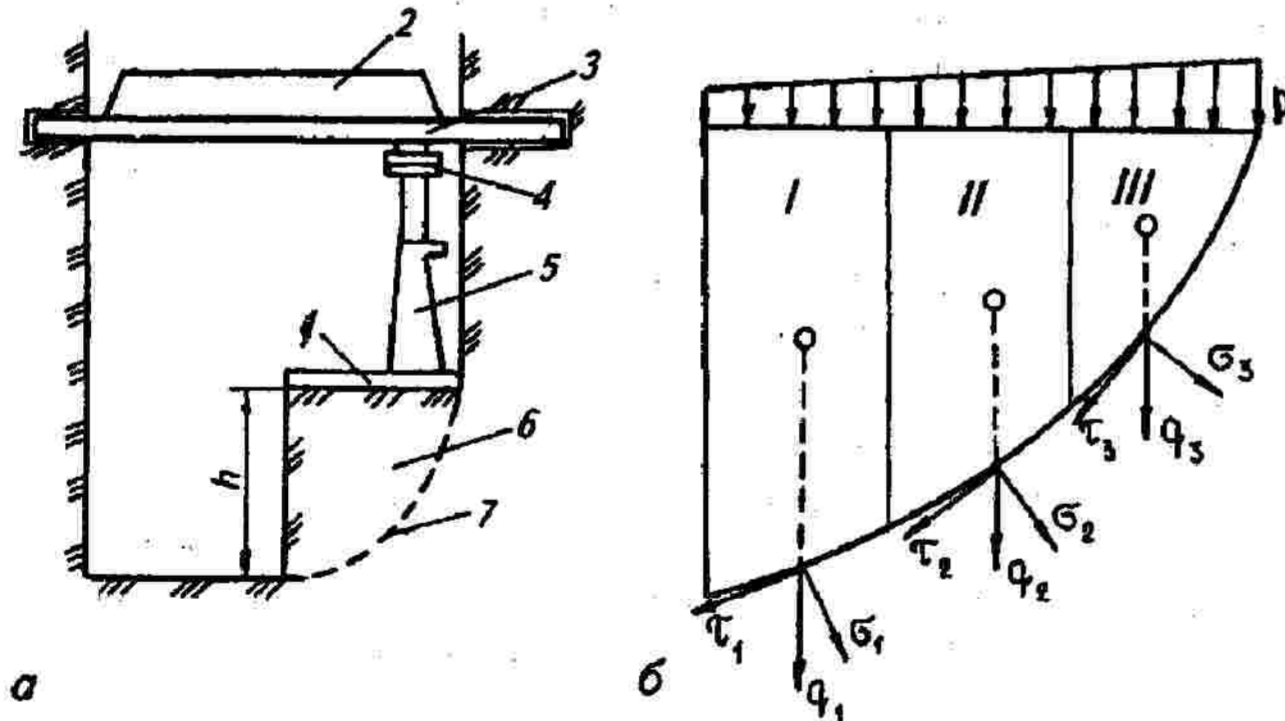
Испытания грунта на сдвиг обрушением:
